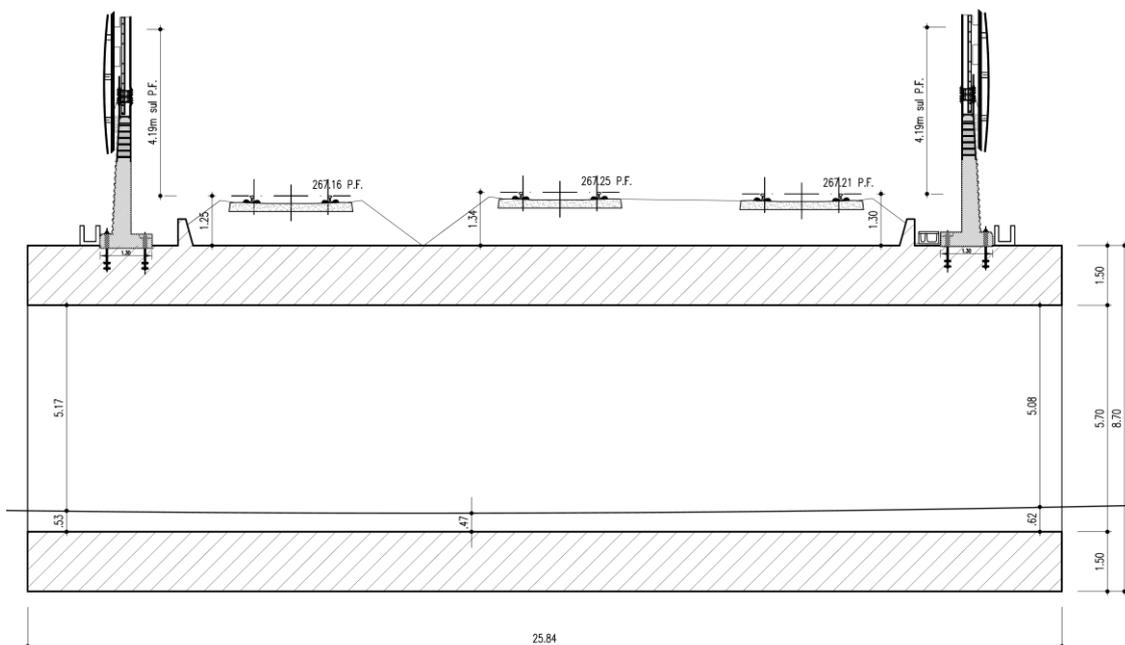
Vista planimetrica della NV04 e del Sottovia SL04
